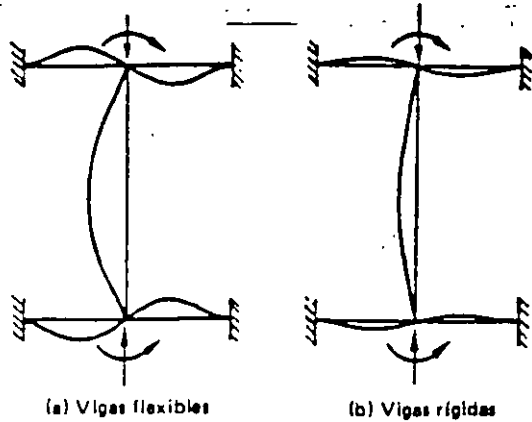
Efecto de la rigidez flexionante de las vigas que restringen a una columna.
